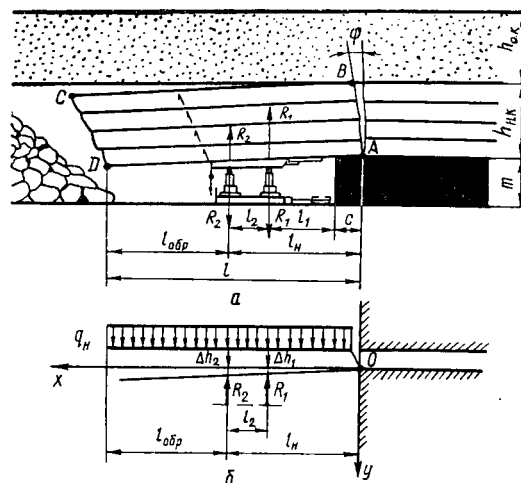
Схема нагружения крепи в лаве при отсутствии осадки основной кровли.
